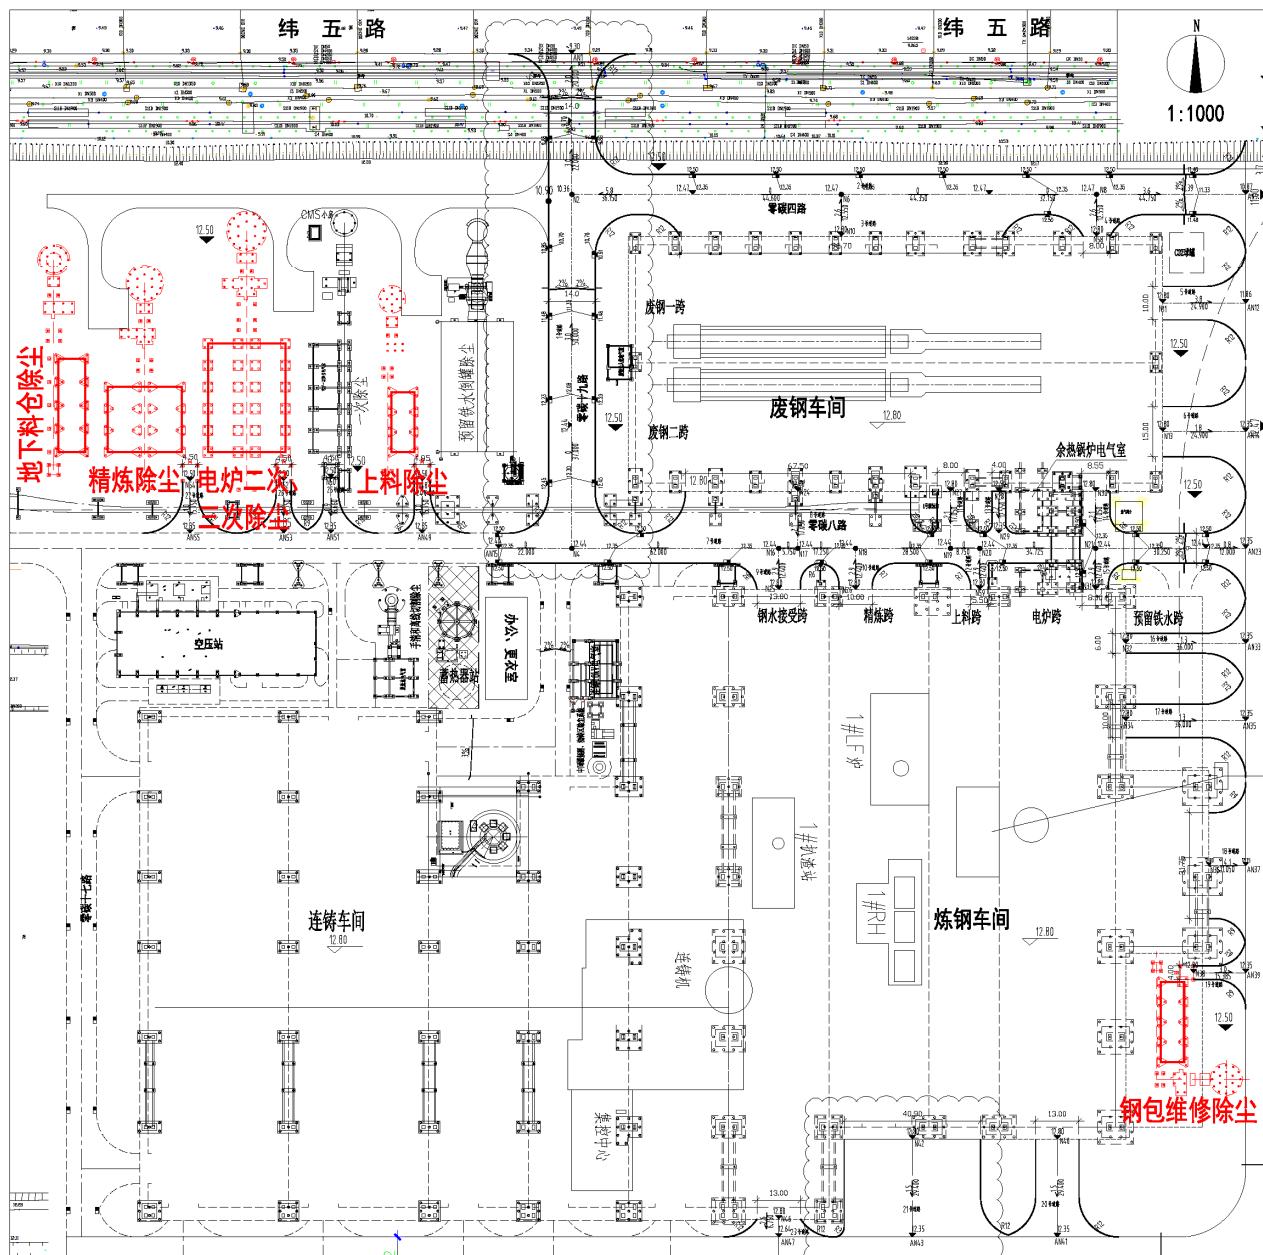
拟建项目在湛江钢铁厂内总平面布置示意图
